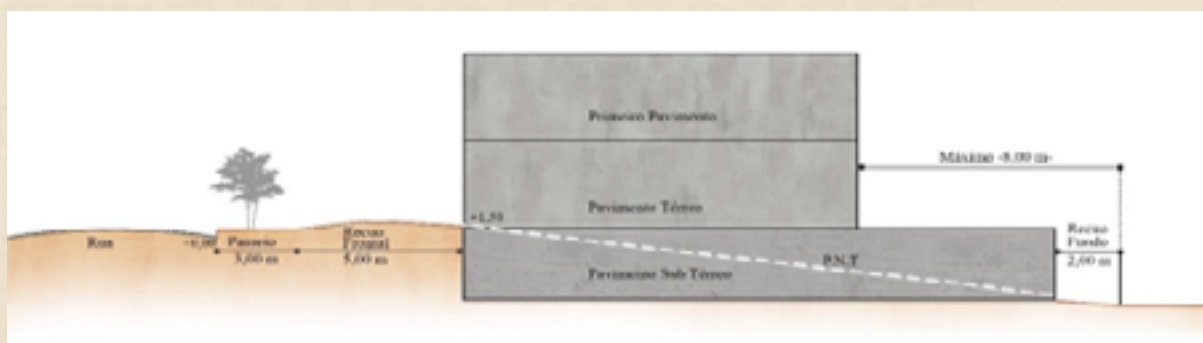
Construção com 3 Pavimentos para Lotes com Declive
